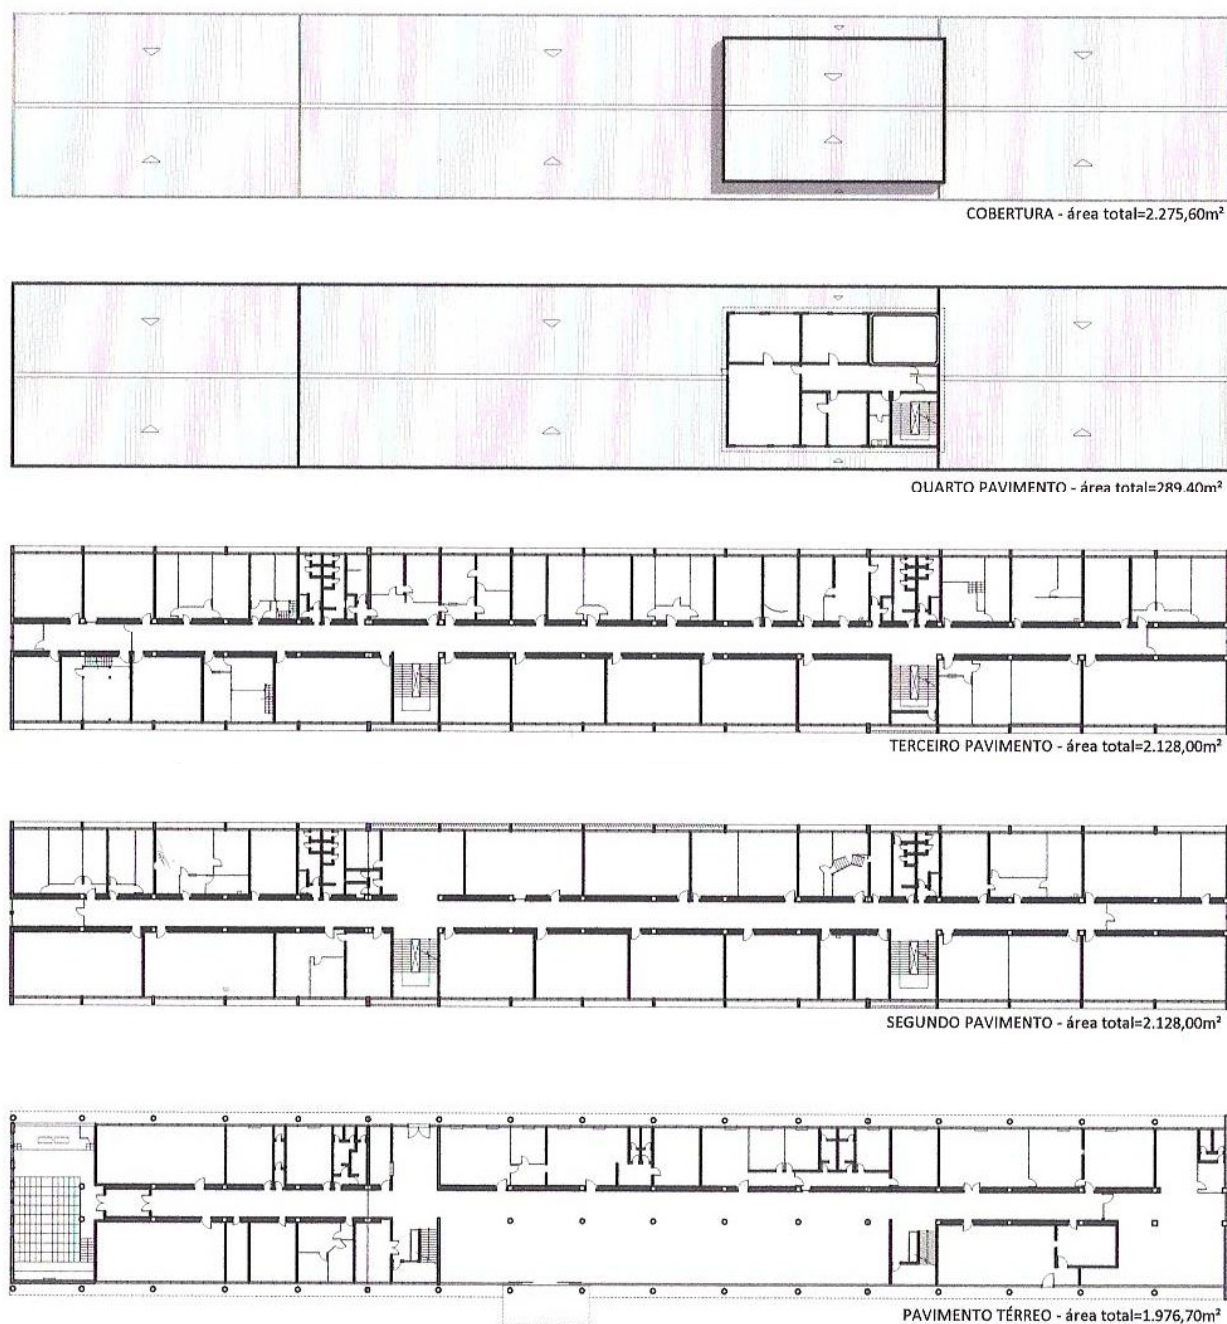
Levantamento físico do edifício – plantas baixas
